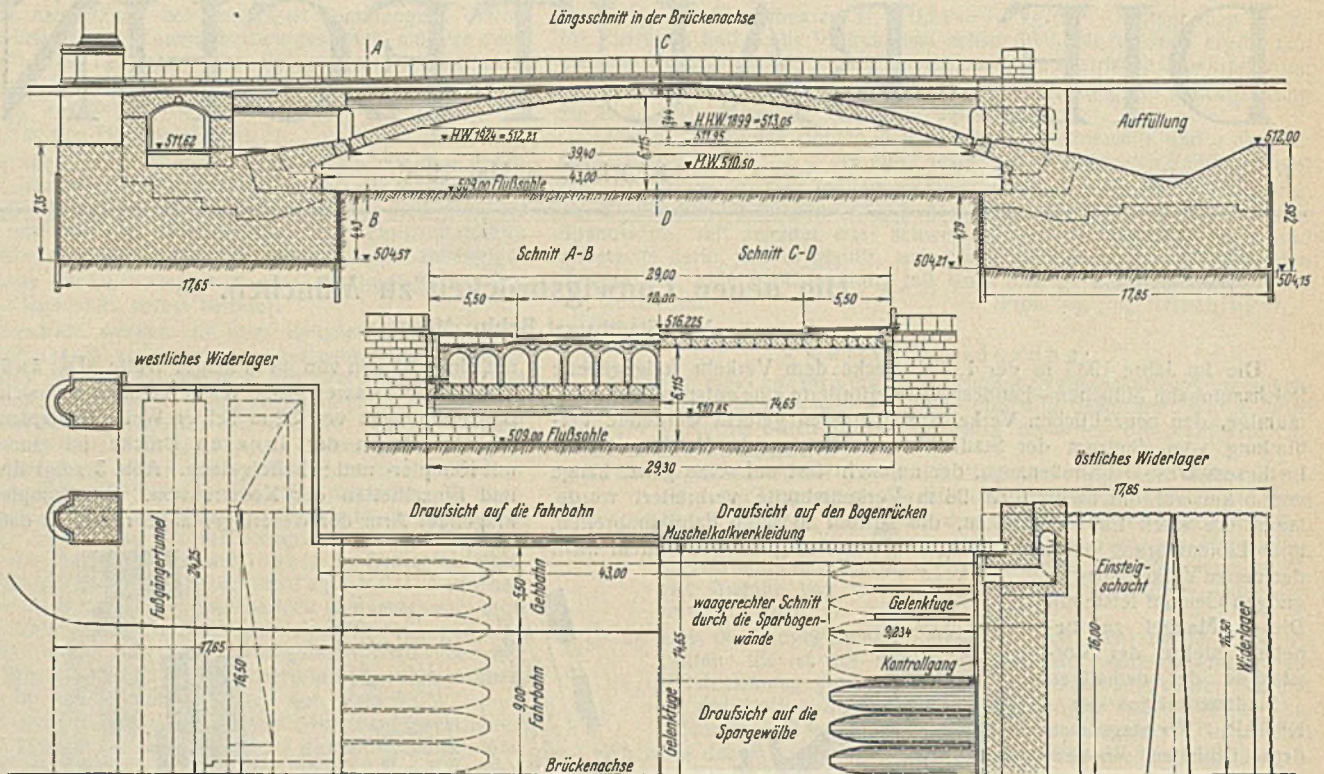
Schnitte und Grundrisse der inneren Ludwigsbrücke.
